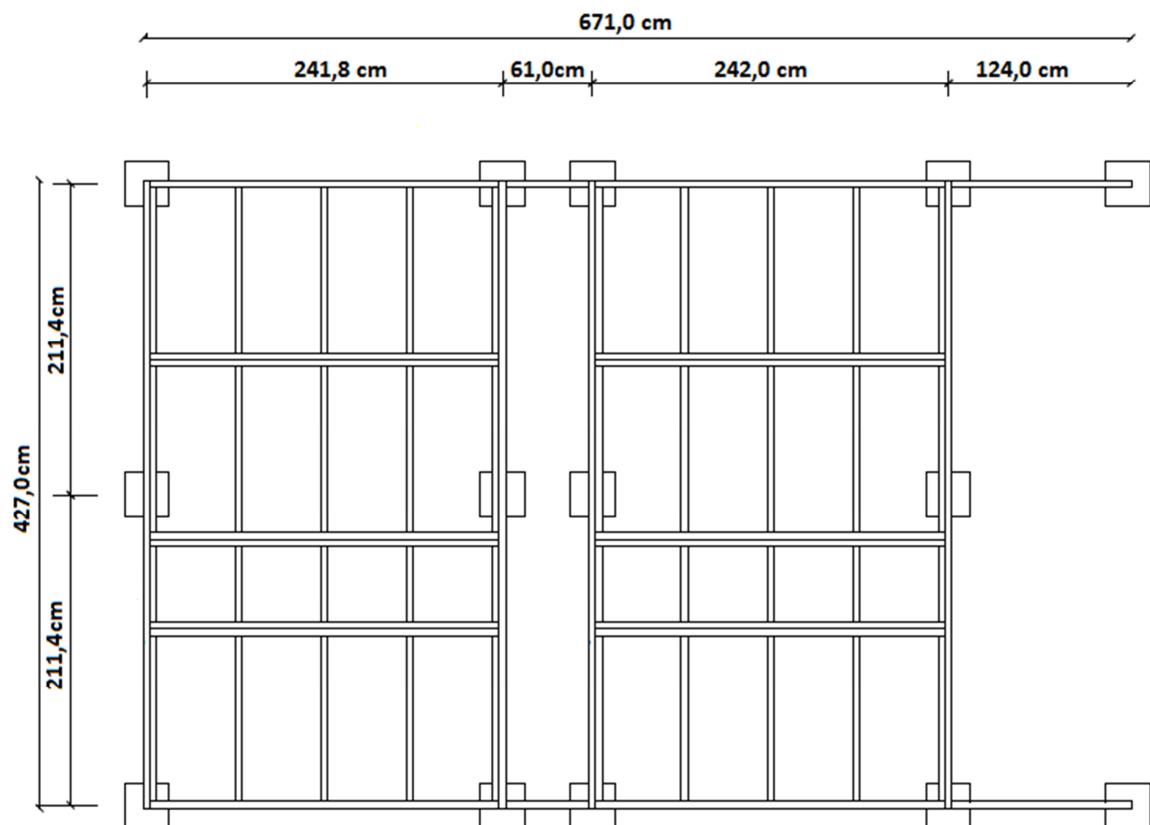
Vista en planta vigas de piso (Vigas periféricas en 2x6" y Vigas interiores en 2x4")
